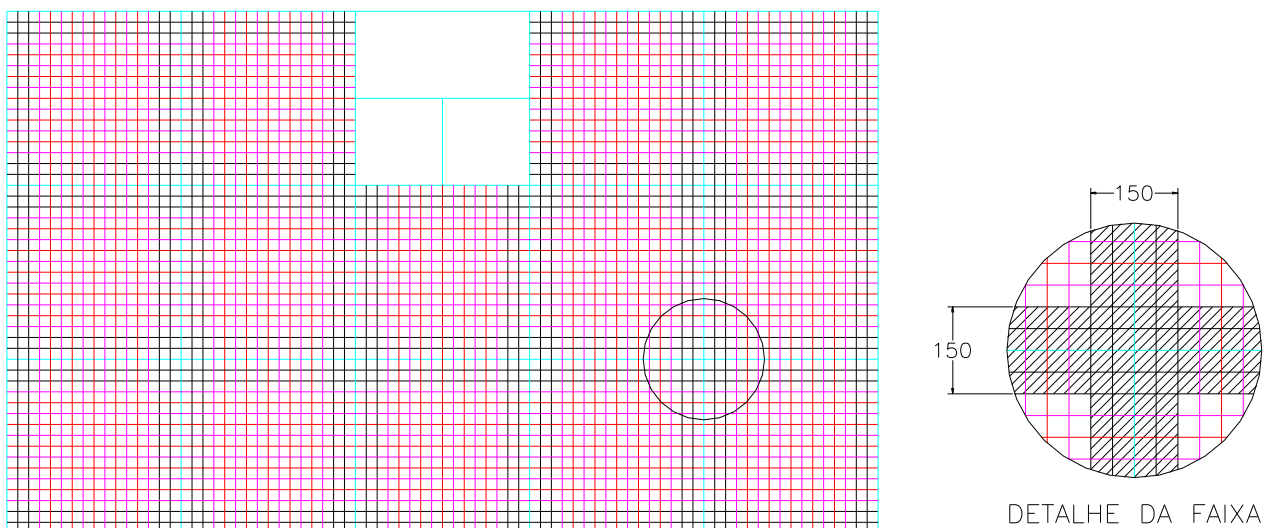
Malha de Elementos Finitos de casca do 1º pavimento.
